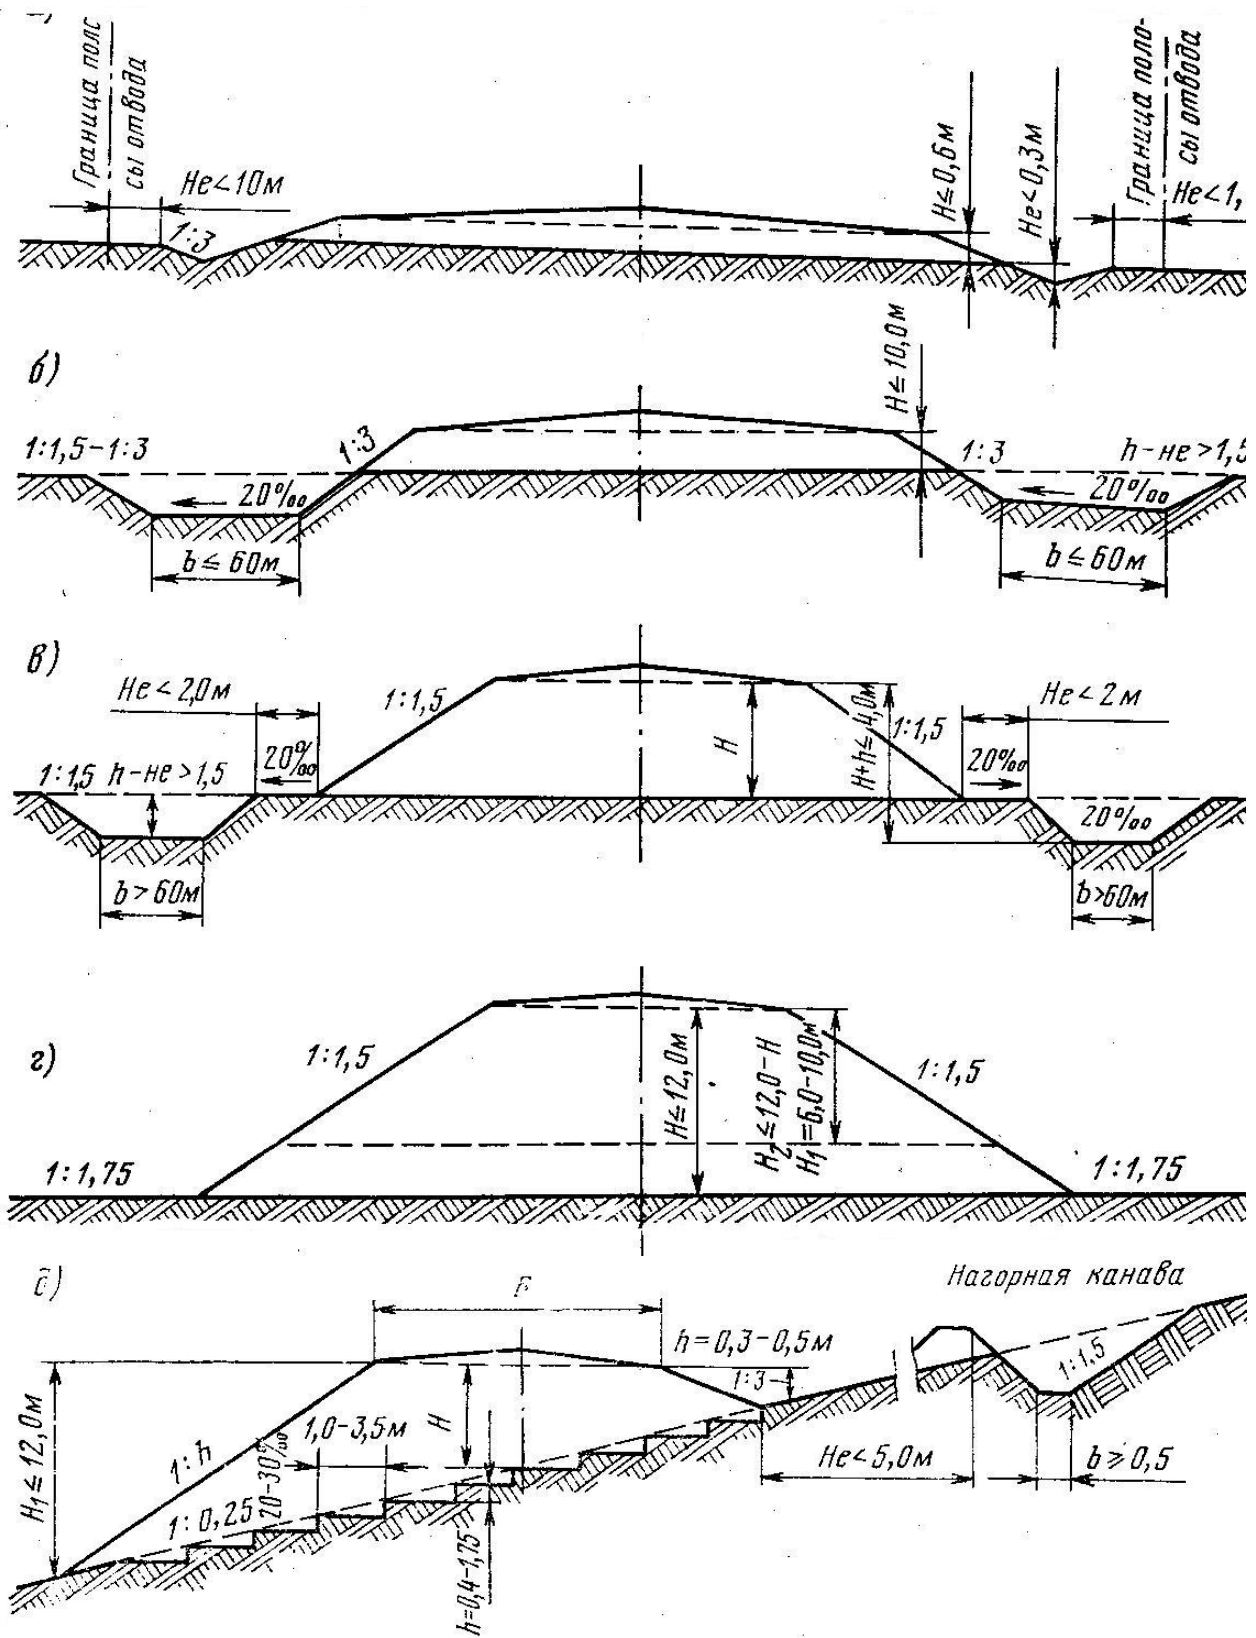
Поперечные профили земляного полотна в насыпях: а – в песчаных и супесчаных грунтах с треугольными кюветами; б- с кюветами-резервами; в - с резервами; г – в высокой насыпи; д – на косогоре
